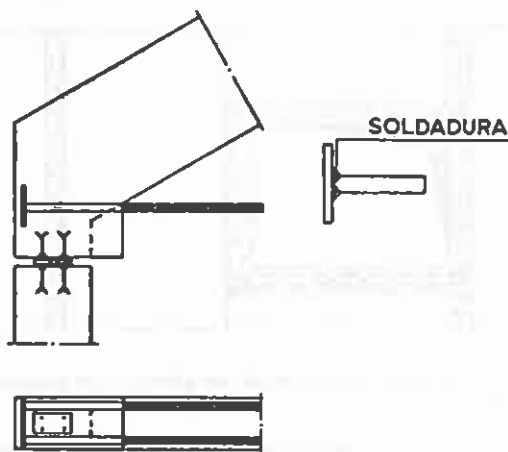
Pormenor de apoio de arco atirantado (2)
